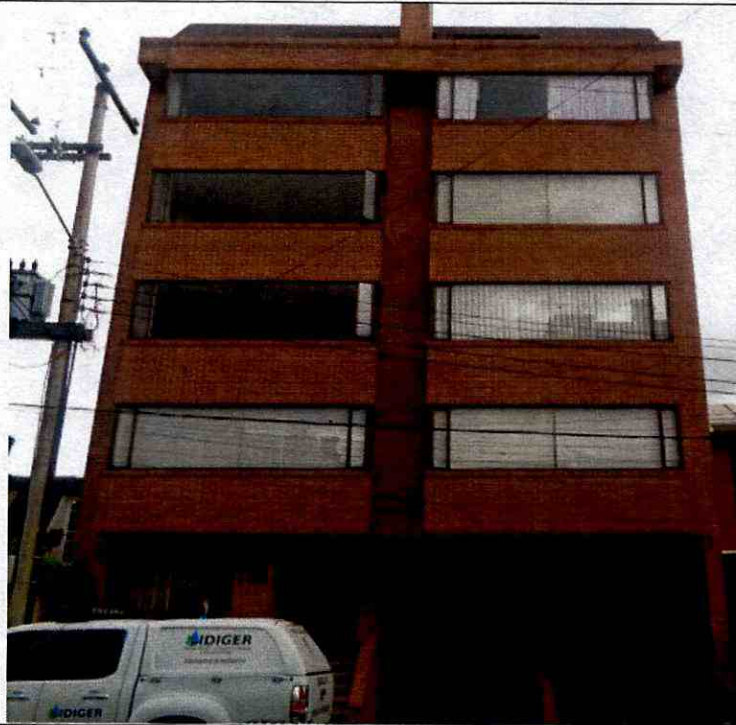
Vista de las fisuras en muros de fachada.
